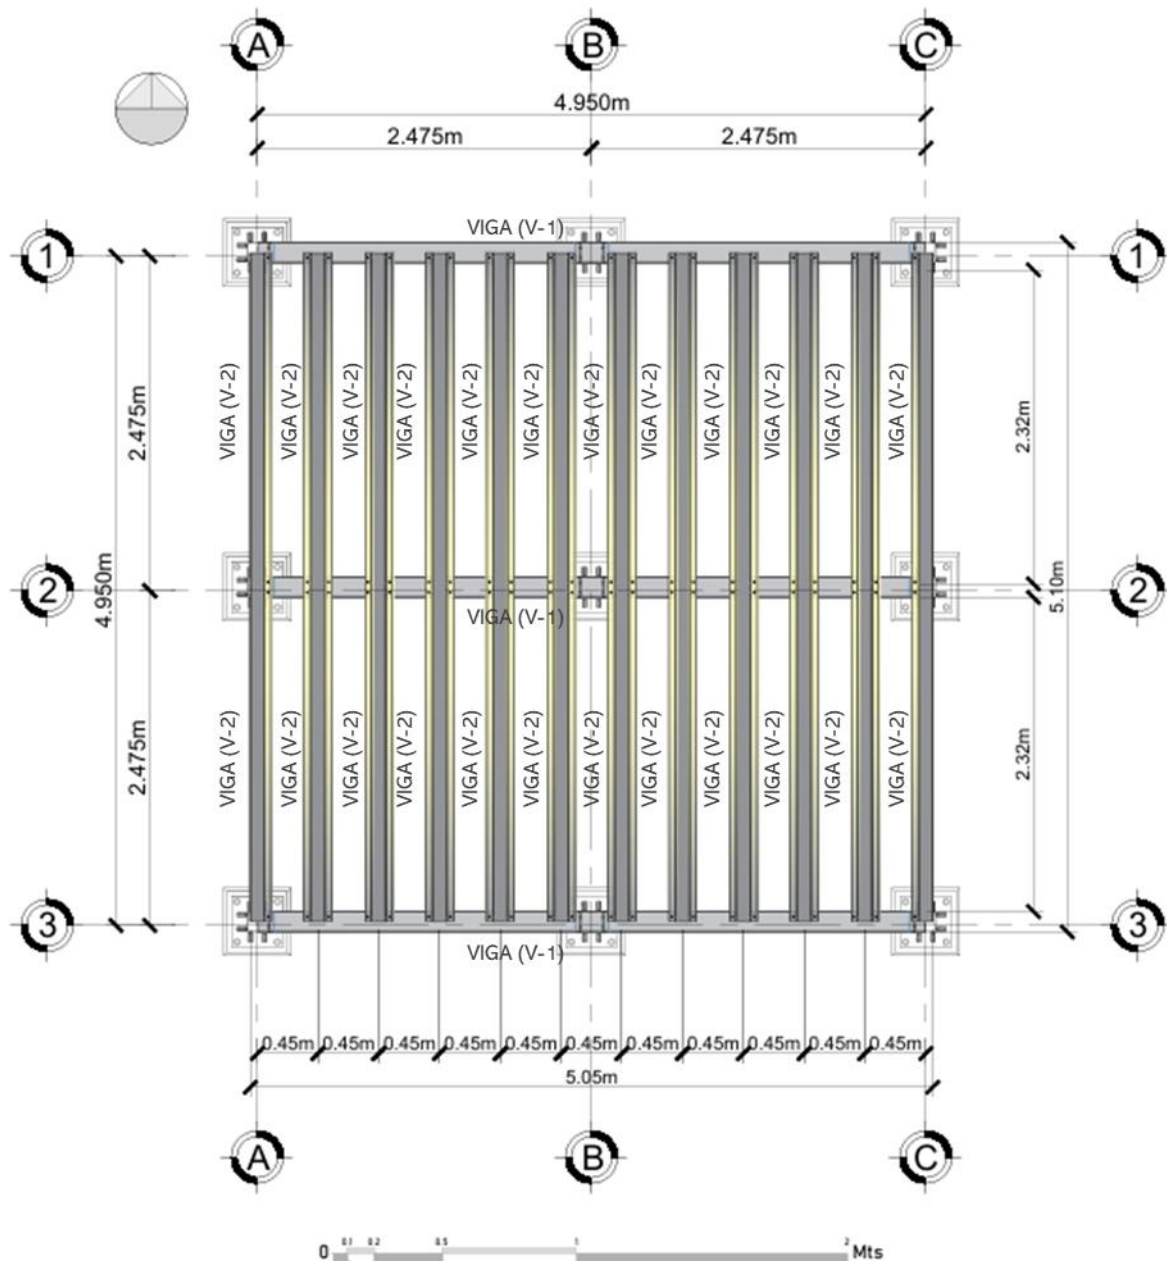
Planta de Entrepiso. Fuente: Elaboración propia
